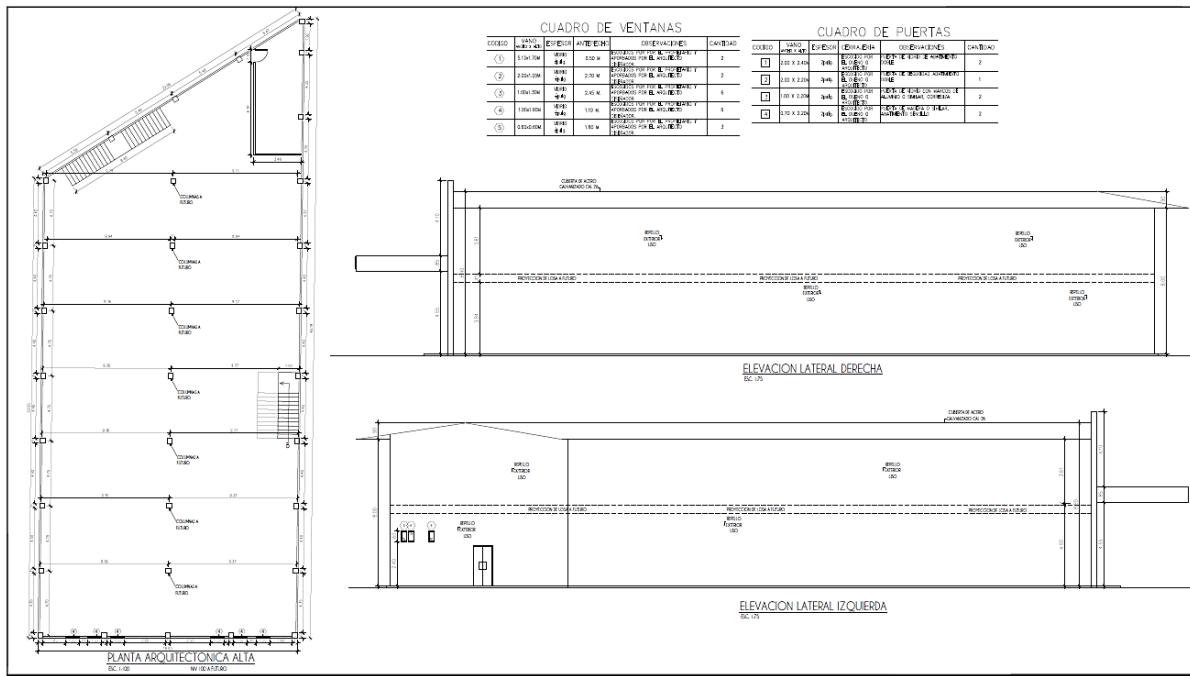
Planta arquitectónica planta alta y elevaciones laterales derecha e izquierda
